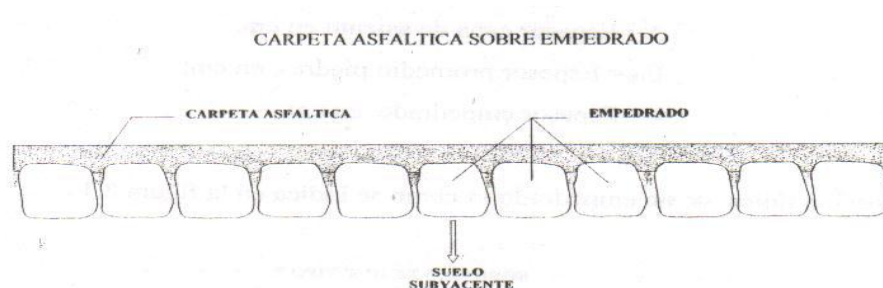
Esquema de un Pavimento sobre Empedrado Fuente: Elaboración Propia
